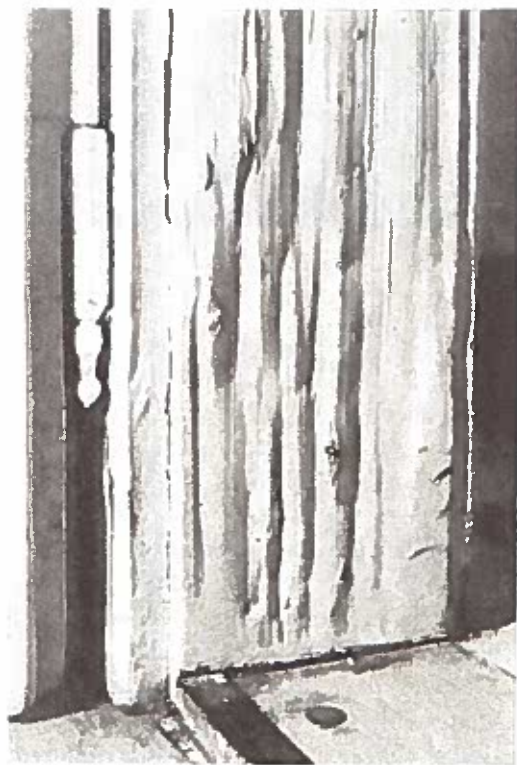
Mit Ölfarbe gestrichenes Holz (Türstock) wird bei Hausschwammbefall auf der Oberfläche deutlich wellig und rissig
